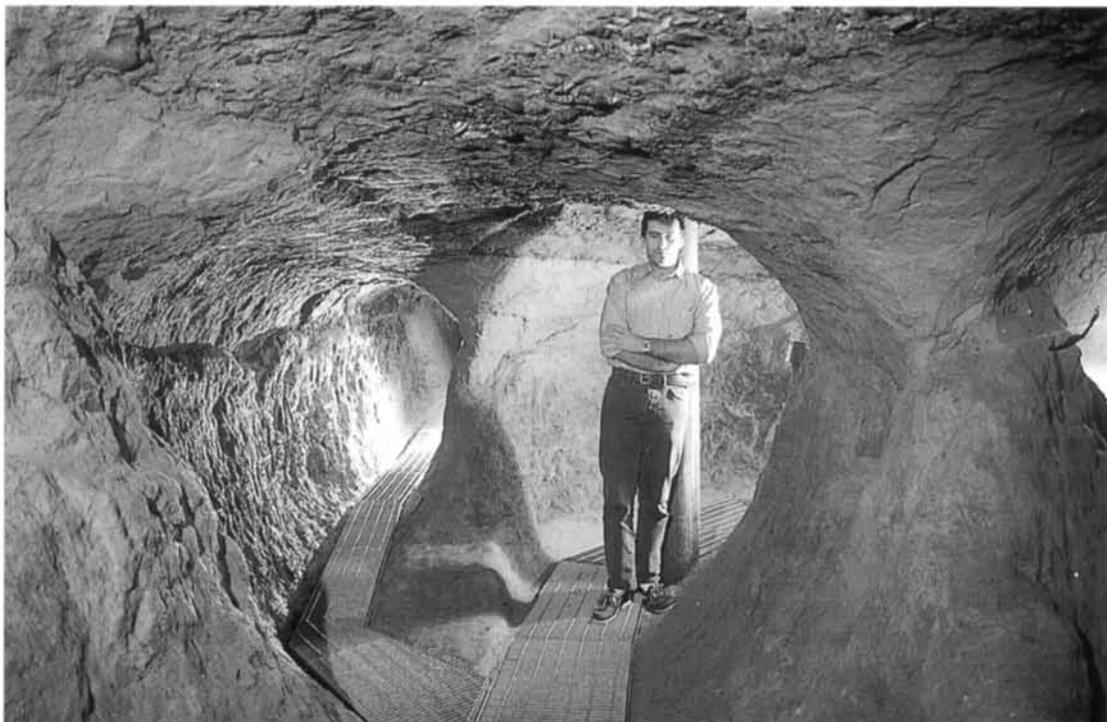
Orvieto: un aspetto dei sotterranei (foto archivio F. Ardito).
